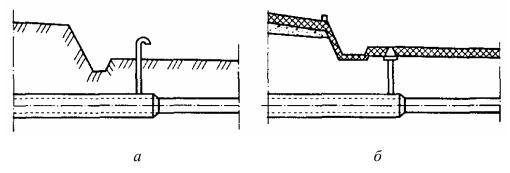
Установка контрольных трубок: a — над поверхностью земли;  $\delta$  — под ковер
